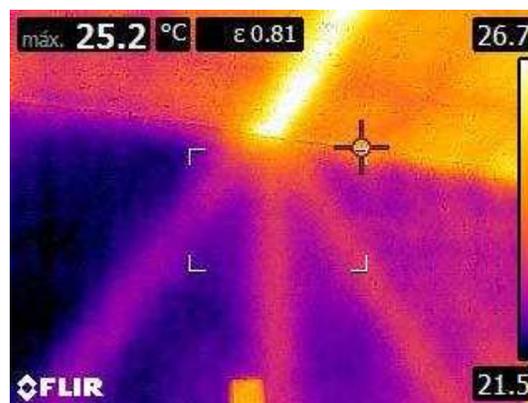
Imagen cámara termográfica sistema terrapanel aplicado en Casa Arias Karmelic
